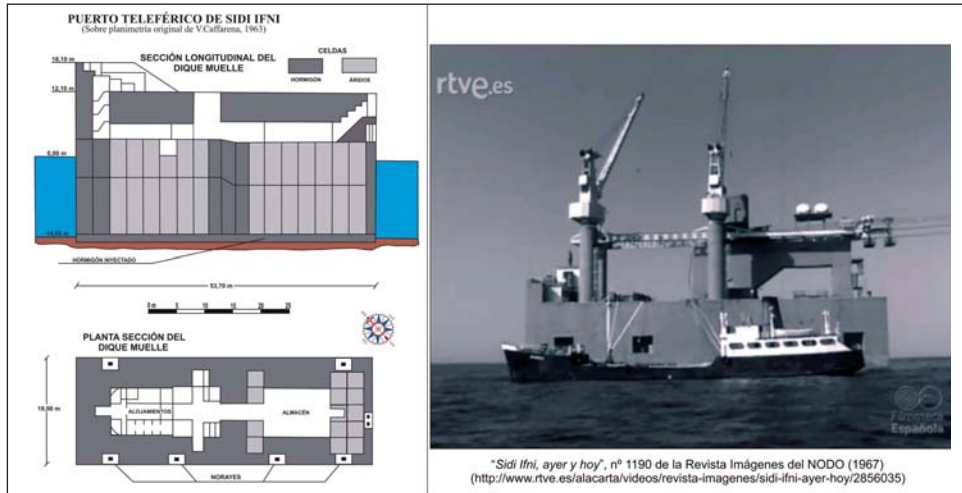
Plano del dique muelle realizado (sobre planimetría original, CAFFARENA 1963a:64) y fotograma de la Revista Imágenes del NODO (nº 1190 de 1967) con la imagen del dique muelle terminado y en uso (www.rtve.es).
